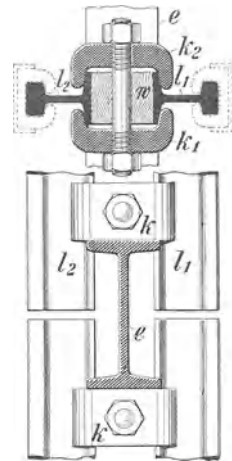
Befestigung der Schachtleitungen bei der Briartschen Führung mit Mitteleinstrich.
